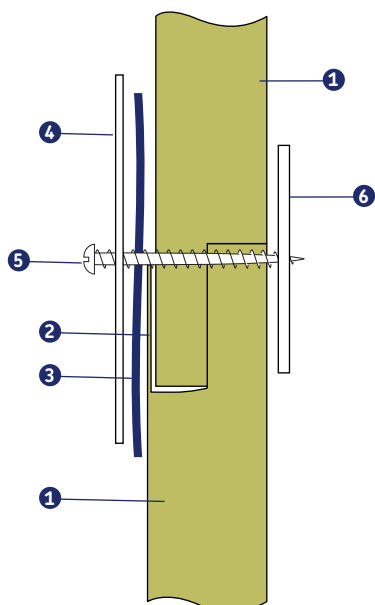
• Mocowanie płyt URSA AIR ZERO A2 25 mm do podkonstrukcji z profili stalowych
